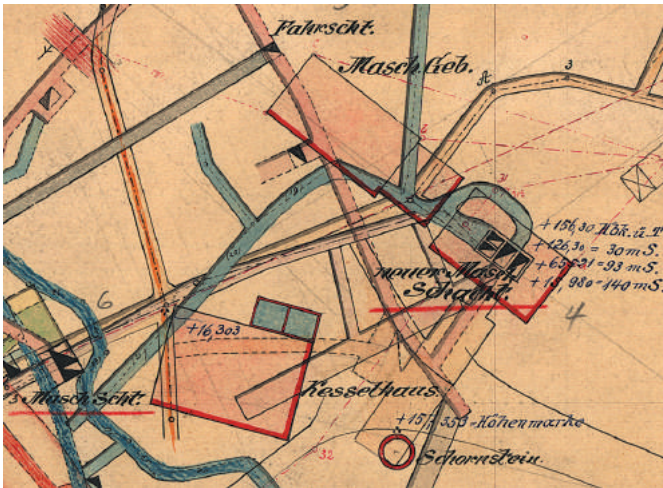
Der neue Schacht und die Betriebsgebäude der Grube Laura, Ausschnitt aus dem Grundriss, Stand April 1909 (ABrA)
